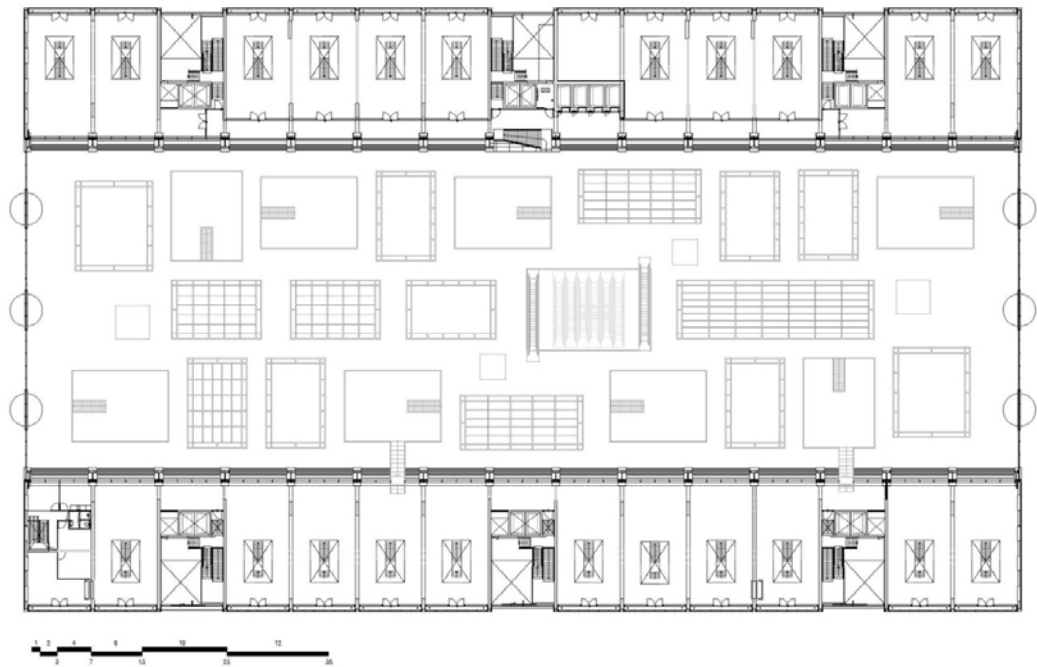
Planta. Fuente: <http://www.archdaily.co>
